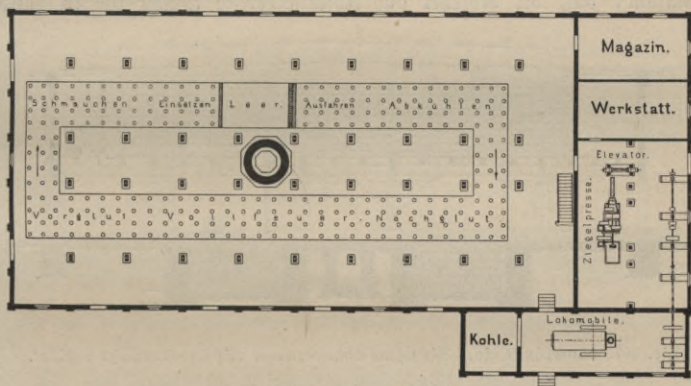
Grundriß einer Dampfziegelei mit Ringofen ohne Gewölbe.
